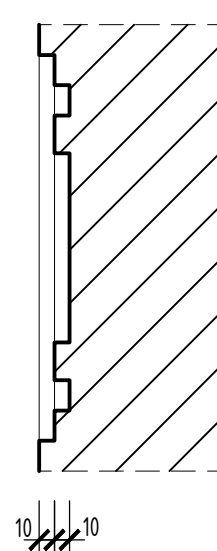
DETAIL VYZNAČENIA ROKU VÝSTAVBY 1:50
